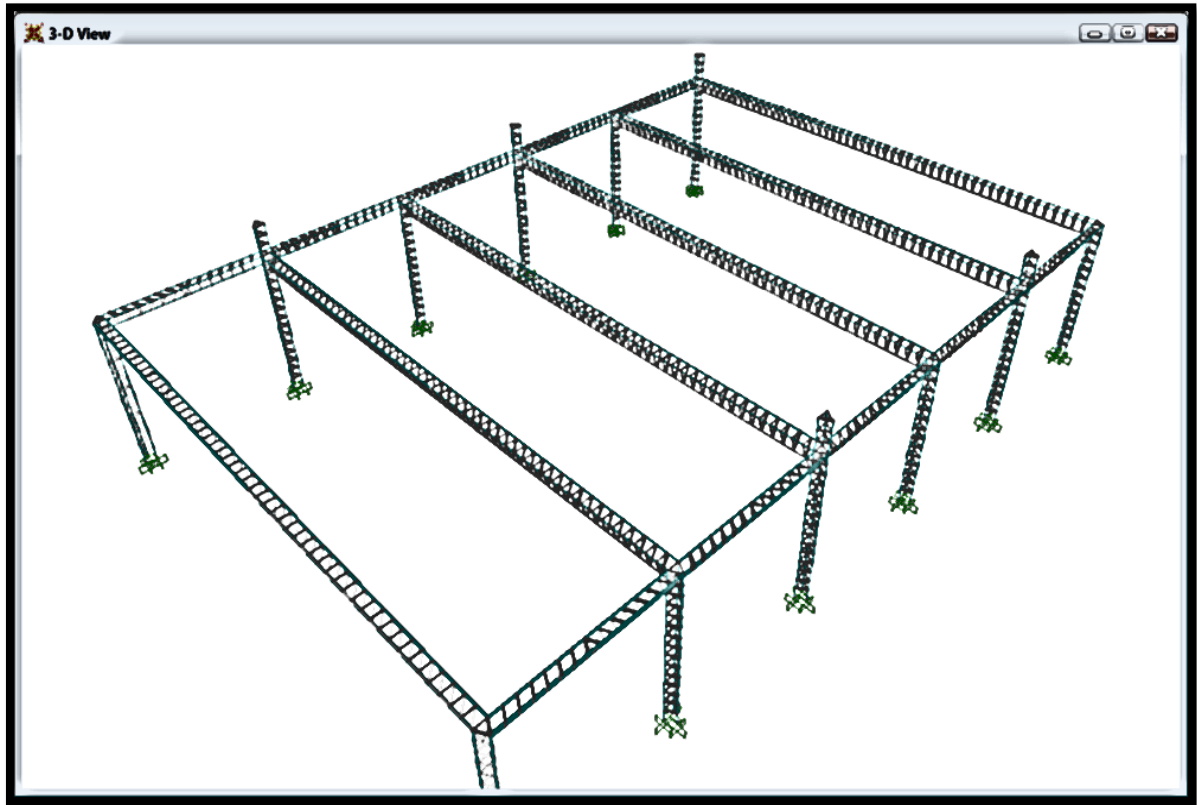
PERFILES DE ARMADURA DE COBERTURA ANFITEATRO
